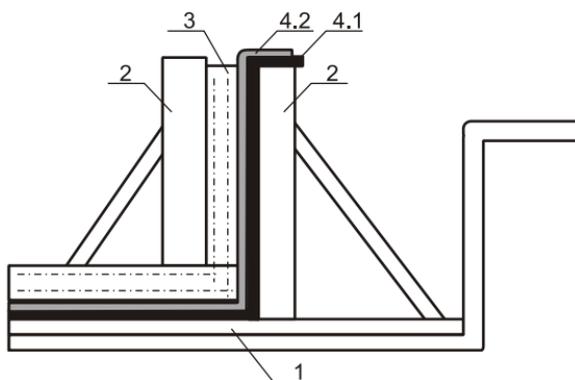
Схема подготовки бетонного фундамента с гидроизоляцией «ЭПИКРОМ» к заливке бетонной смеси в опалубку:
